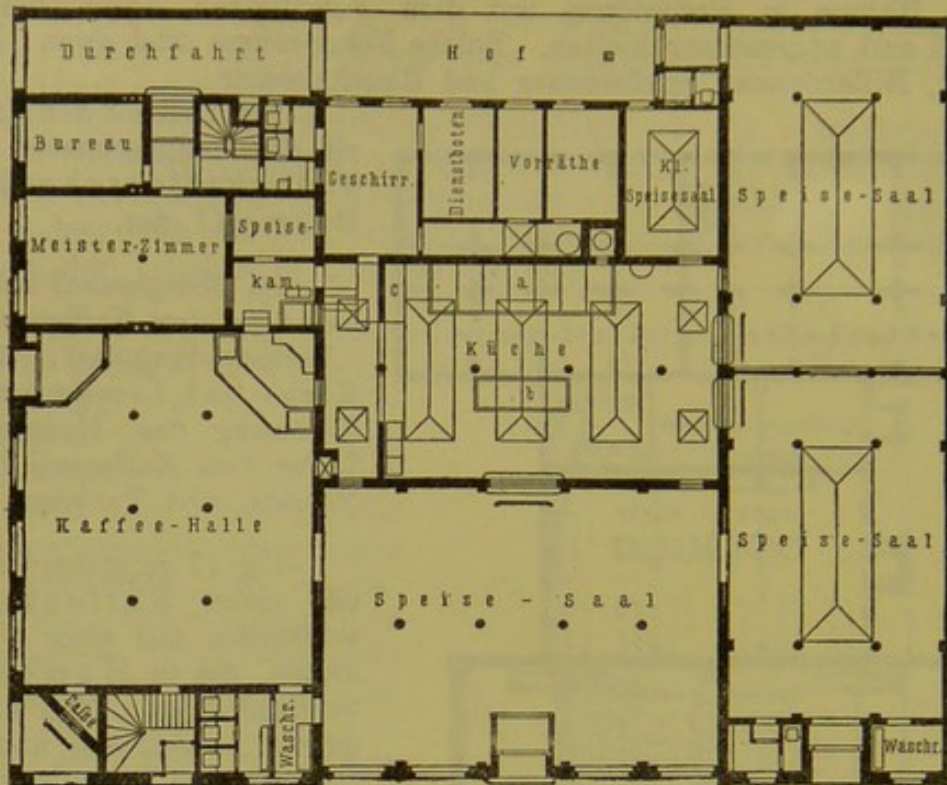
Kaffeehalle verbunden mit Volksküche in Hamburg. Grundrifs. Architekten Hallier und Fitschen, welchen wir die Zeichnung zu Fig. 17 verdanken.
